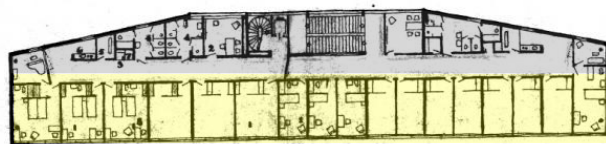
Planta pavimento tipo | Fonte: maisondubresil.org
